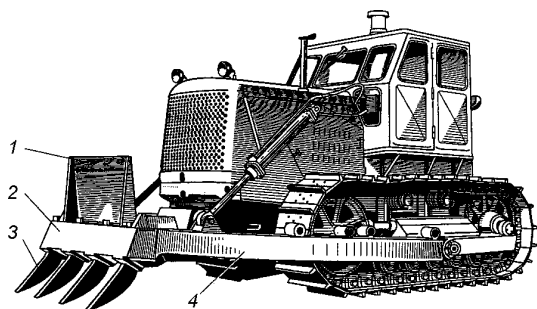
Гусеничный корчеватель–собираатель: 1 – отвал; 2 – рабочая балка; 3 – корчующие зубья; 4 – толкающая рама
